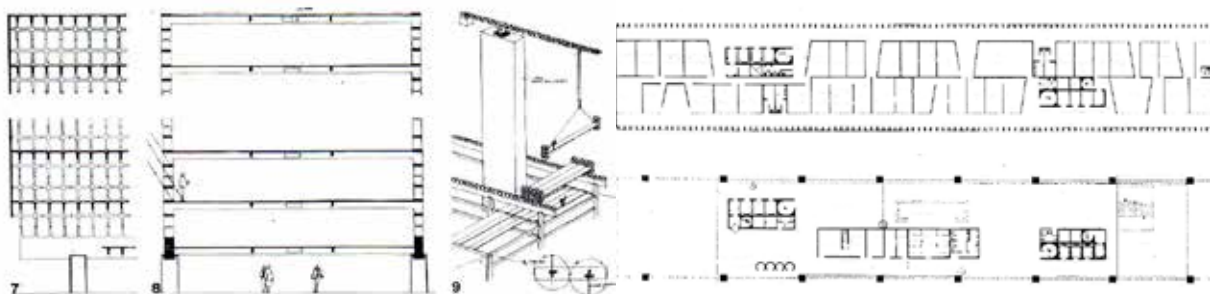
2º prêmio Departamento Federal de Segurança Pública; elevação, corte transversal, esquema de construção por sistema pré fabricado, plantas térreo, planta subsolo.
